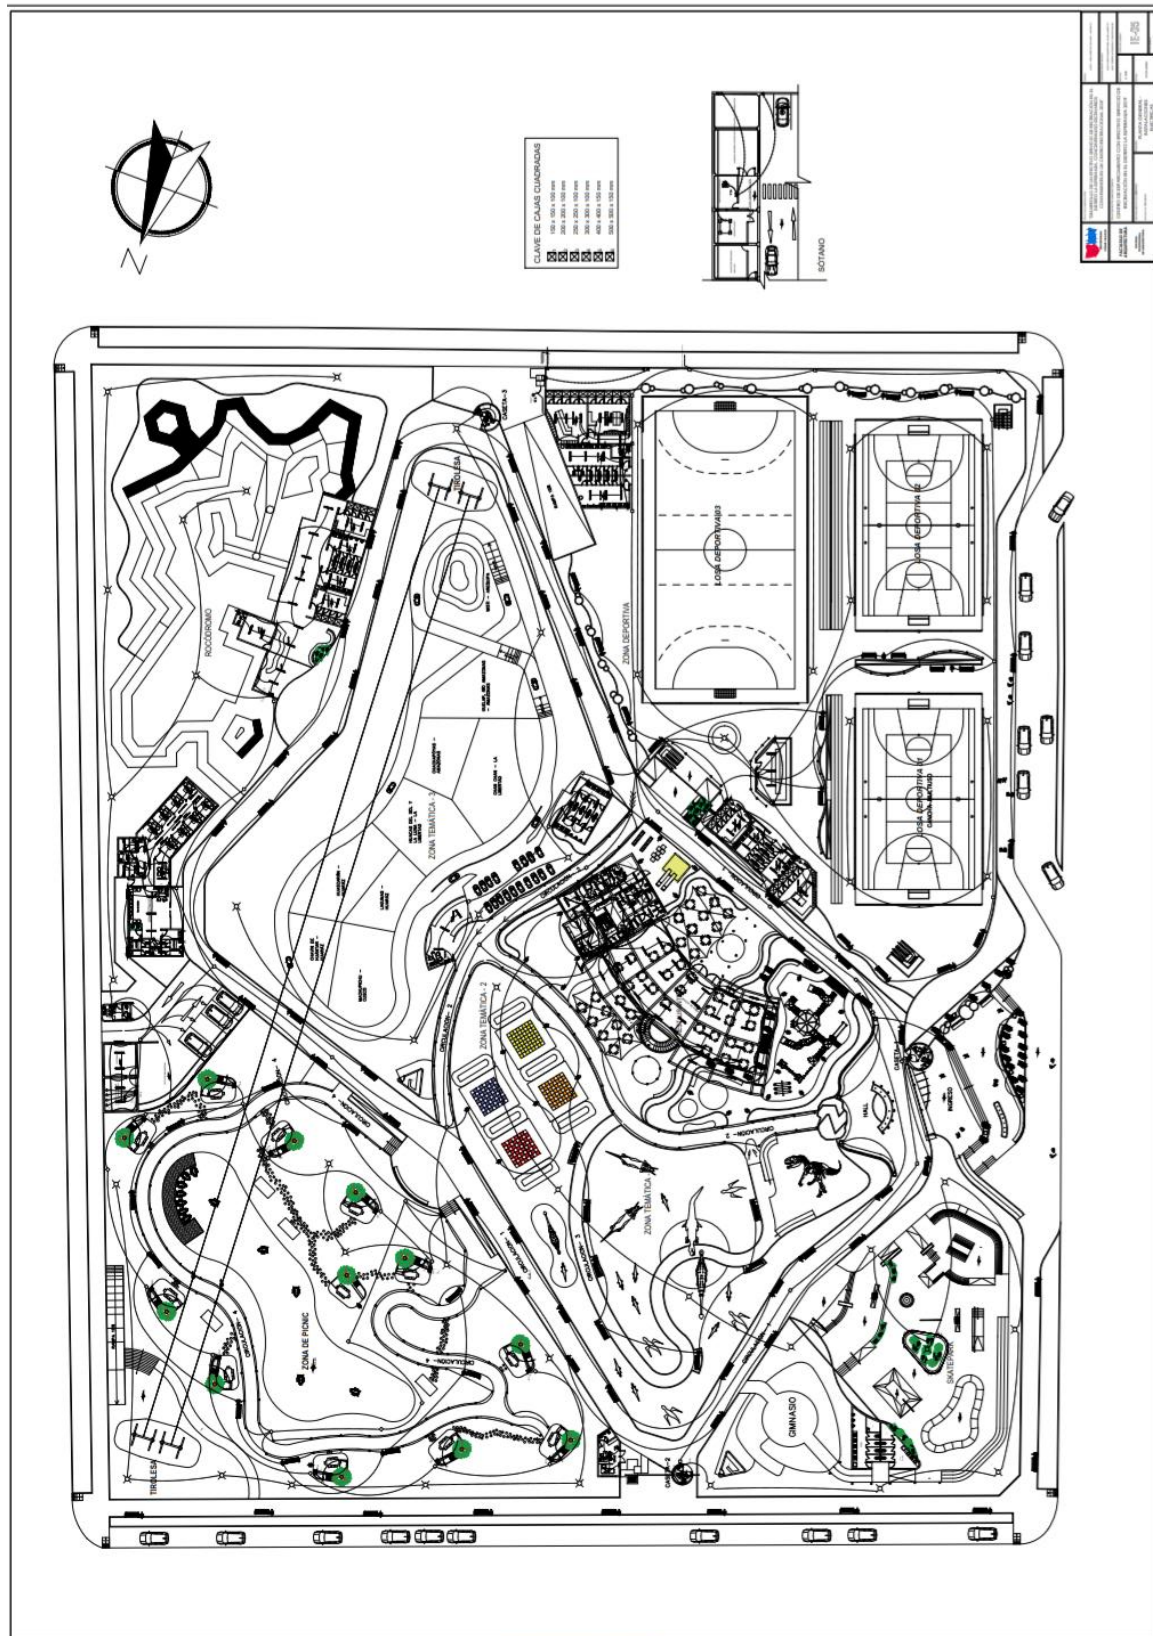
Plano de Instalaciones Eléctricas Planta General. Elaboración propia.
